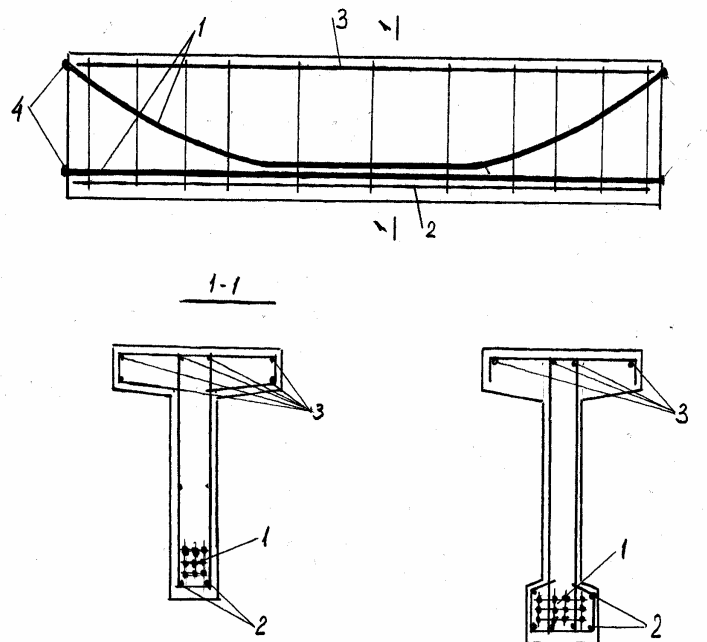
Розташування попередньо напруженої арматури в перерізі балки:
